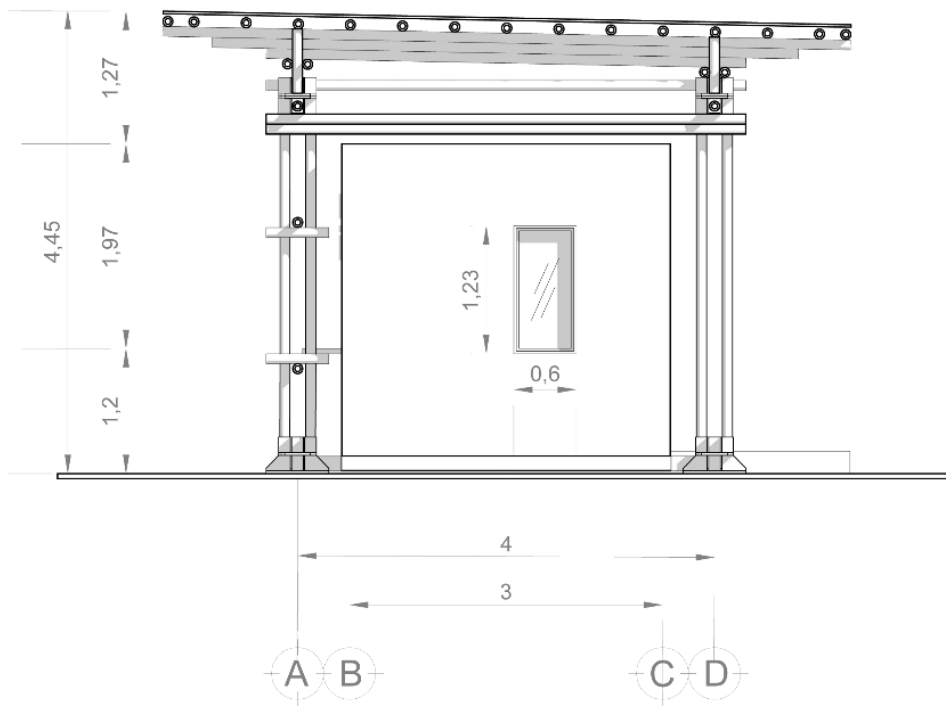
Fachada Sur. Fuente: Gerardo A., 2022.
